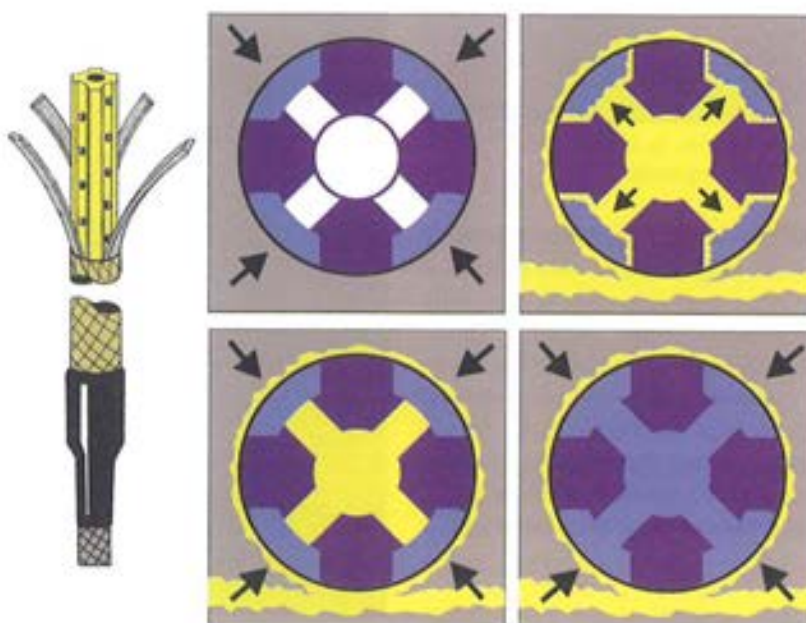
Detalle de manguera FUKO y fases de la inyección y lavado.
